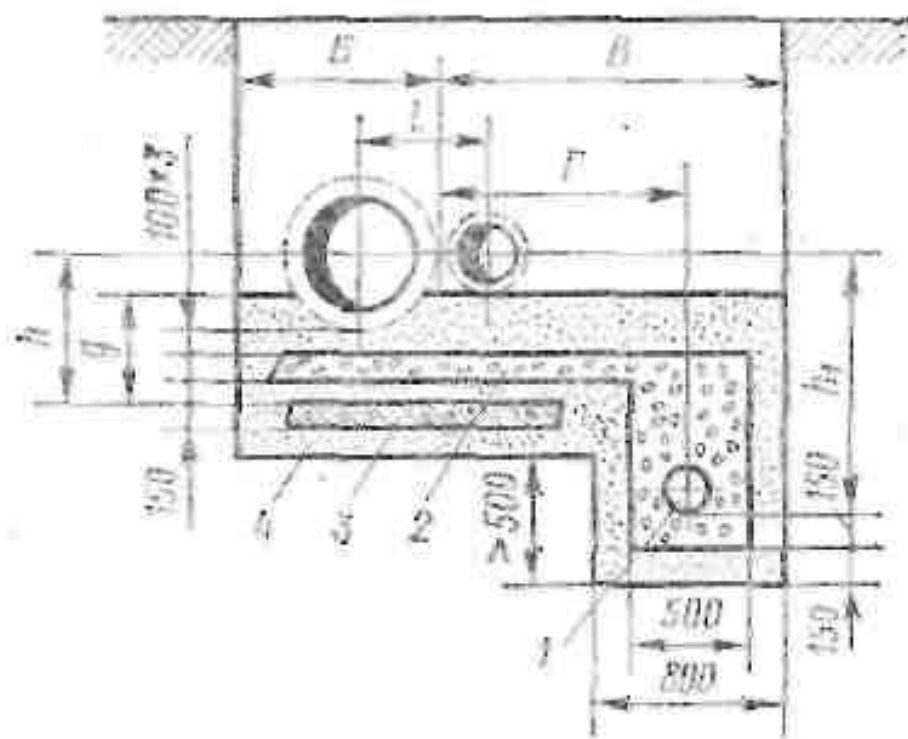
Типовая конструкция продольного дренажа бесканальных прокладок в слабых грунтах;
